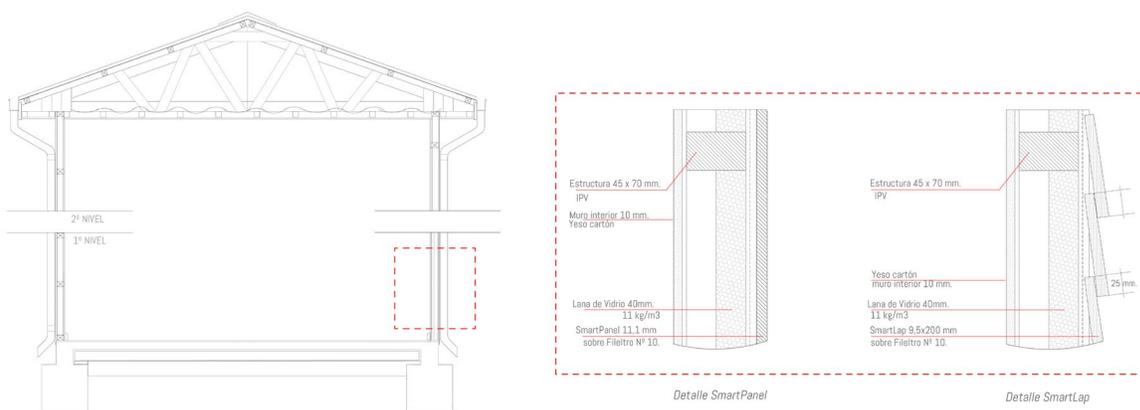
Detalle constructivo de techo. Proyecto Villa Sargento Candelaria
